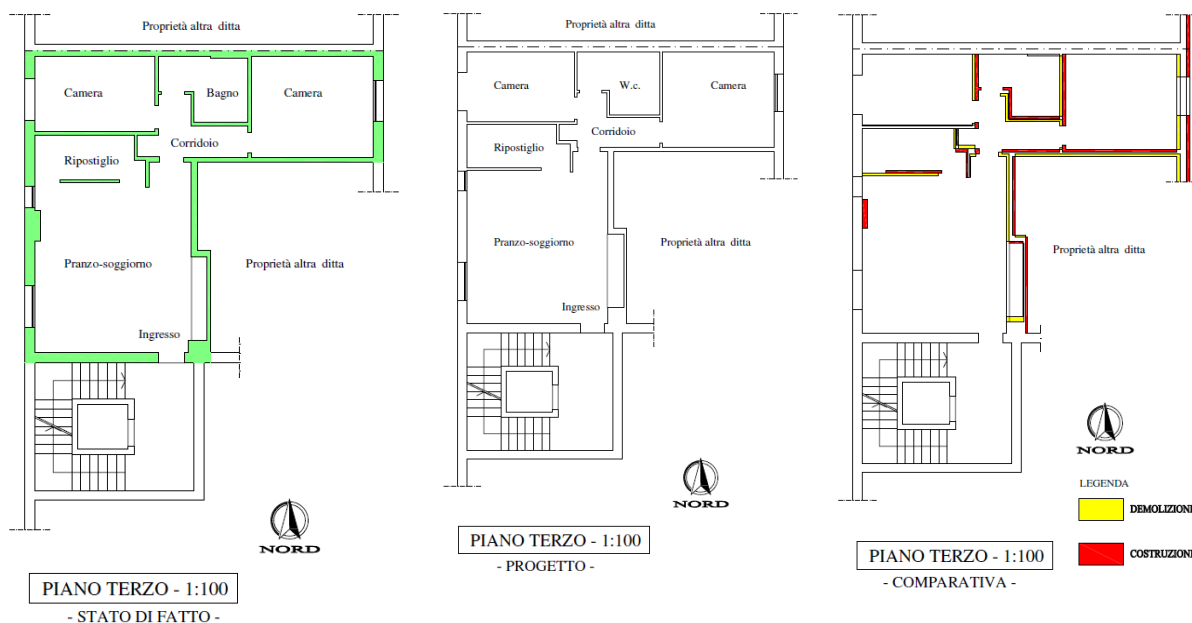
Planimetrie appartamento - stato di fatto – progetto – comparativa (fuori scala) – [\(Allegato N.3\)](#)
